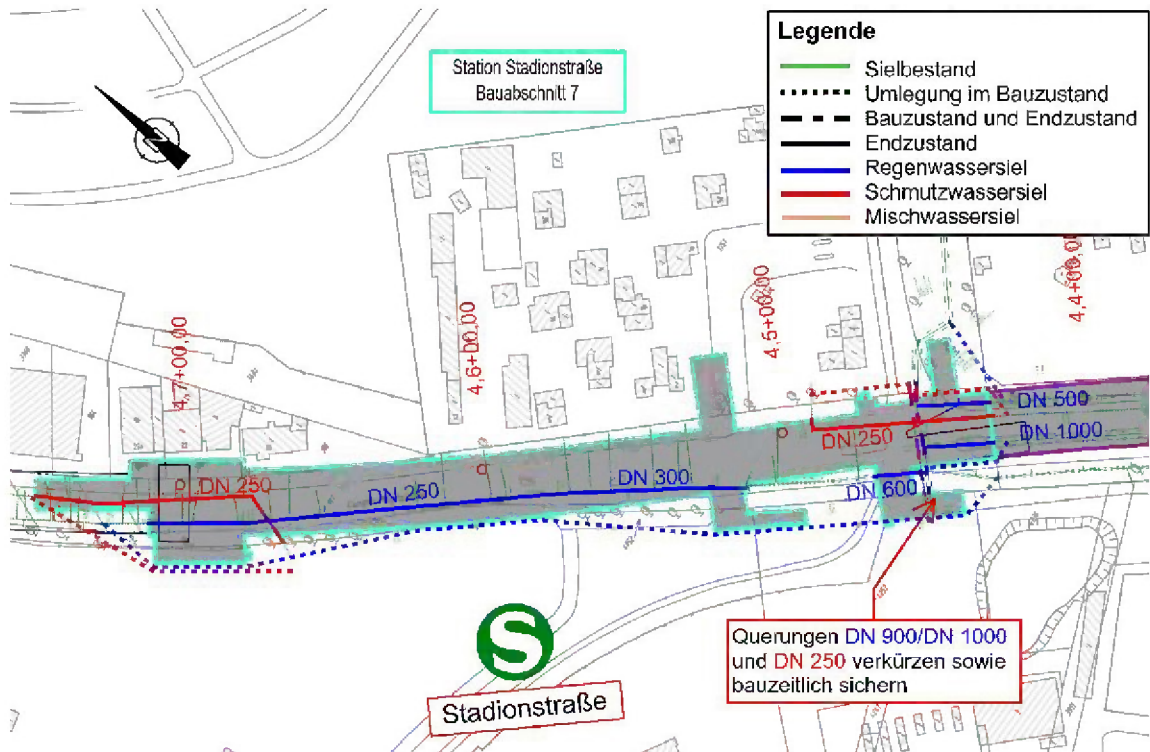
Sielplan Baubereich Station Stadionstraße, Bauabschnitt 7 (Stand 04.2019)
